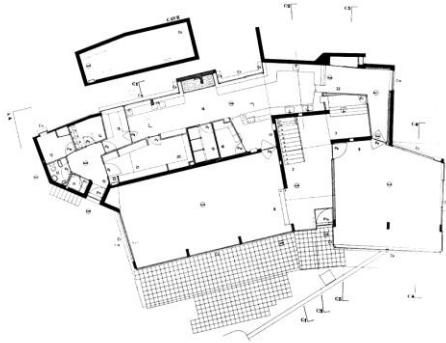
| Restaurante – Planta | archtendencias.com.br
